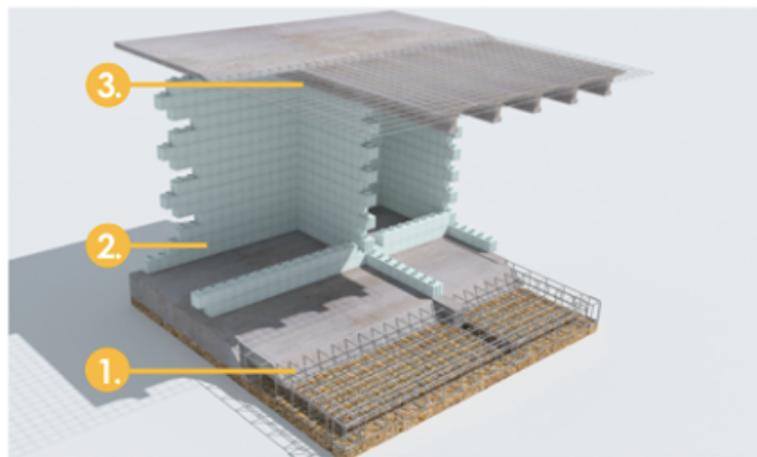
Sistema constructivo Legoblock. Fuente: (Legoblock., 2018)
